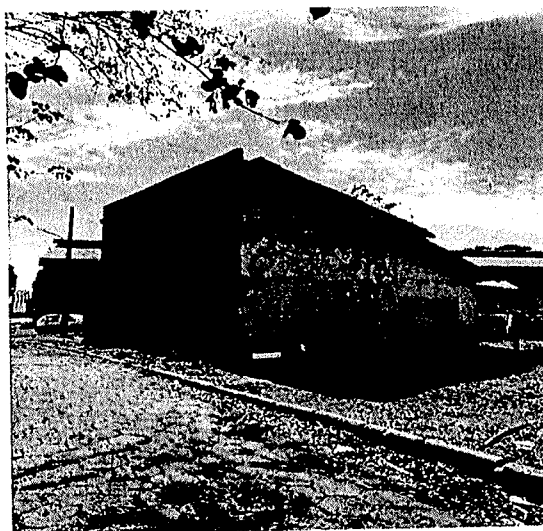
Vista externa da edificação auxiliar. A edificação apresenta estrutura em alvenaria, com paredes executadas em blocos cerâmicos, emboçadas externamente, sem aplicação de pintura. A cobertura é composta por estrutura de madeira e telhamento em telhas cerâmicas.
